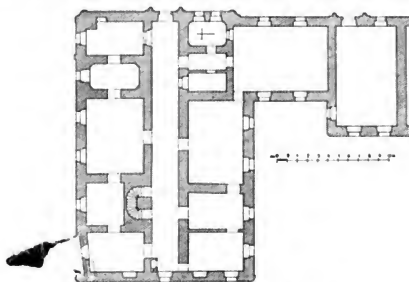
Sudowitz. Grundriss des Schlosses.
